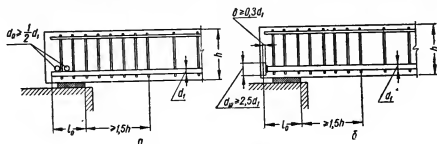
Анкеровка сварных каркасов на свободных опорах балок приваркой к продольным стержням дополнительных анкерующих стержней или шайб:
